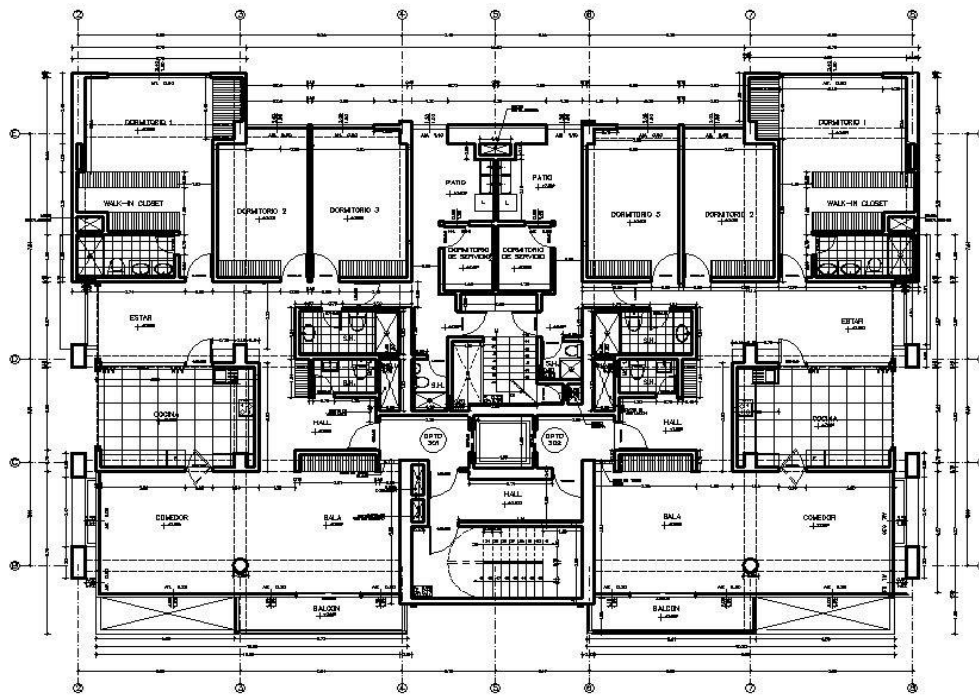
Plantas Típicas – Niveles 3°, 7°, 8°, 9° y 10°
